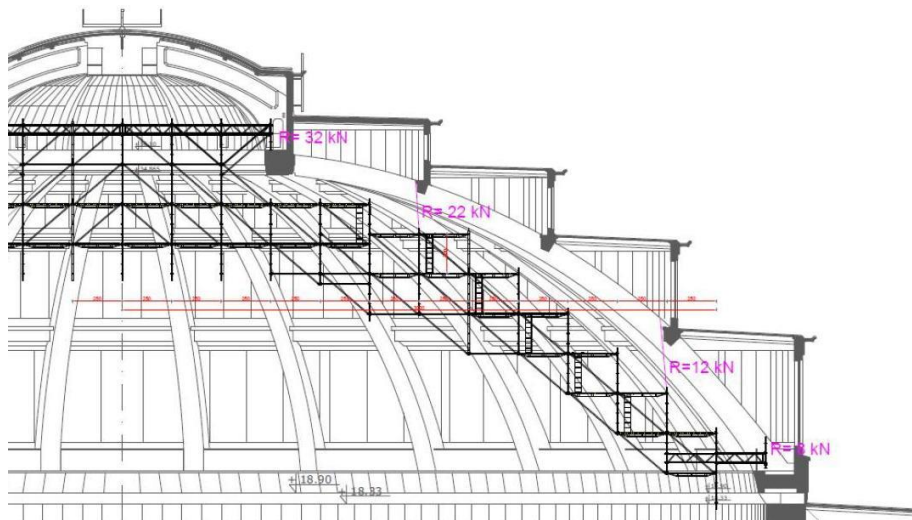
Plan des Hängegerüsts am Kuppeltragwerk
